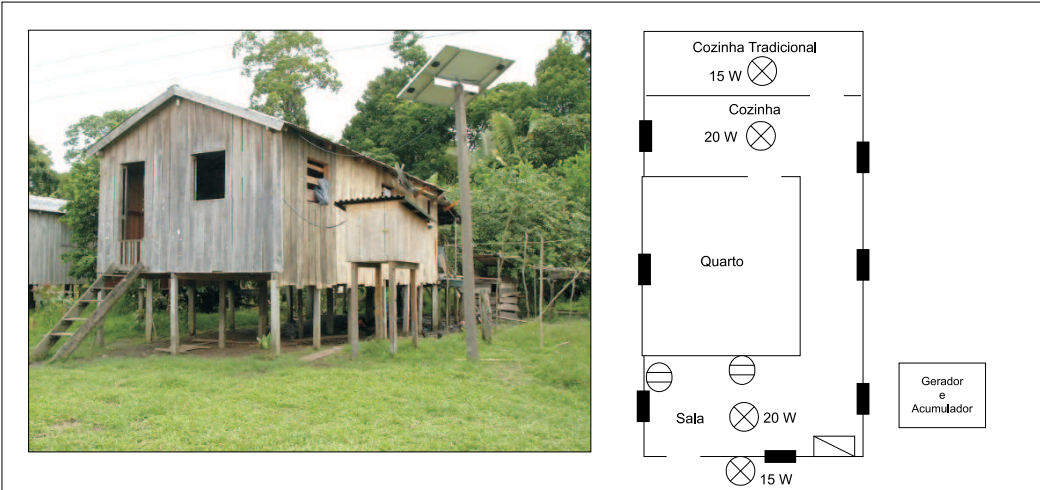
Vista externa do SFD8 e planta aproximada do domicílio.
